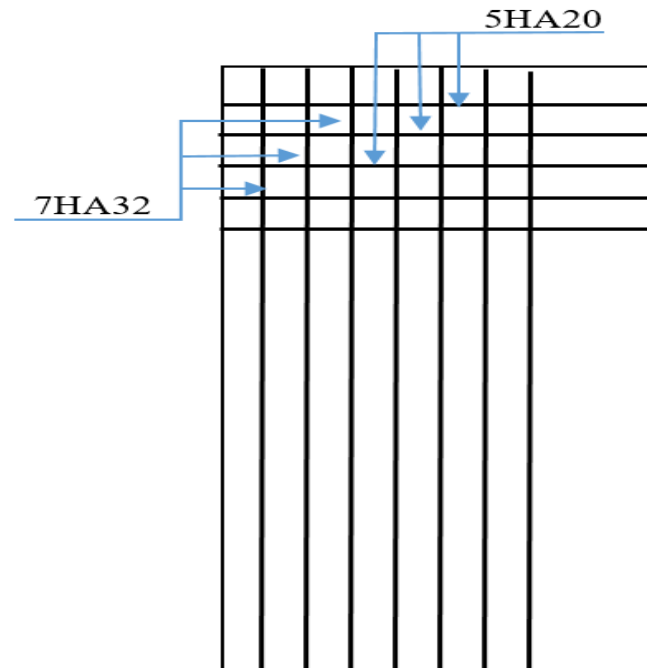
FERRAILLAGE LONGITUDINAL DES FÛTS
